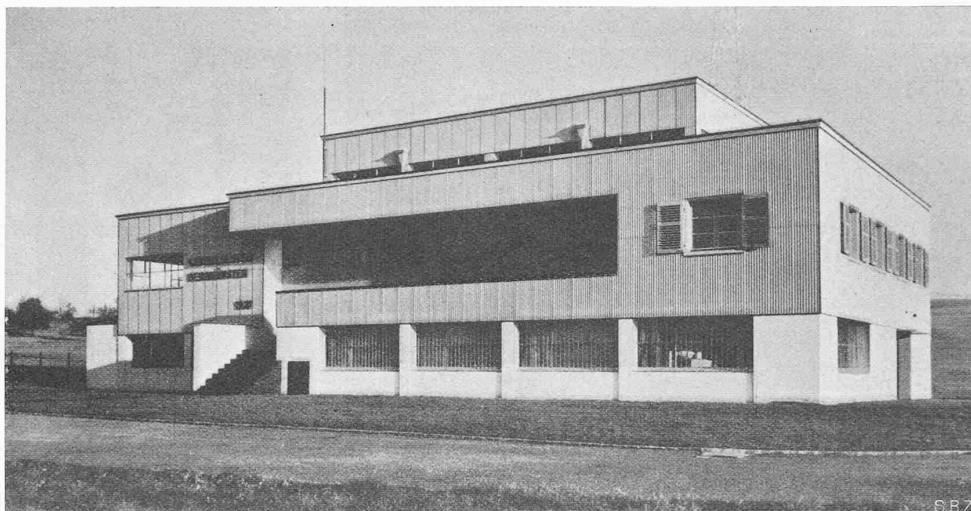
Kleinwellige Eternitverkleidung eines Betonbaues zwecks Wärme- und Feuchtigkeits-Isolierung
